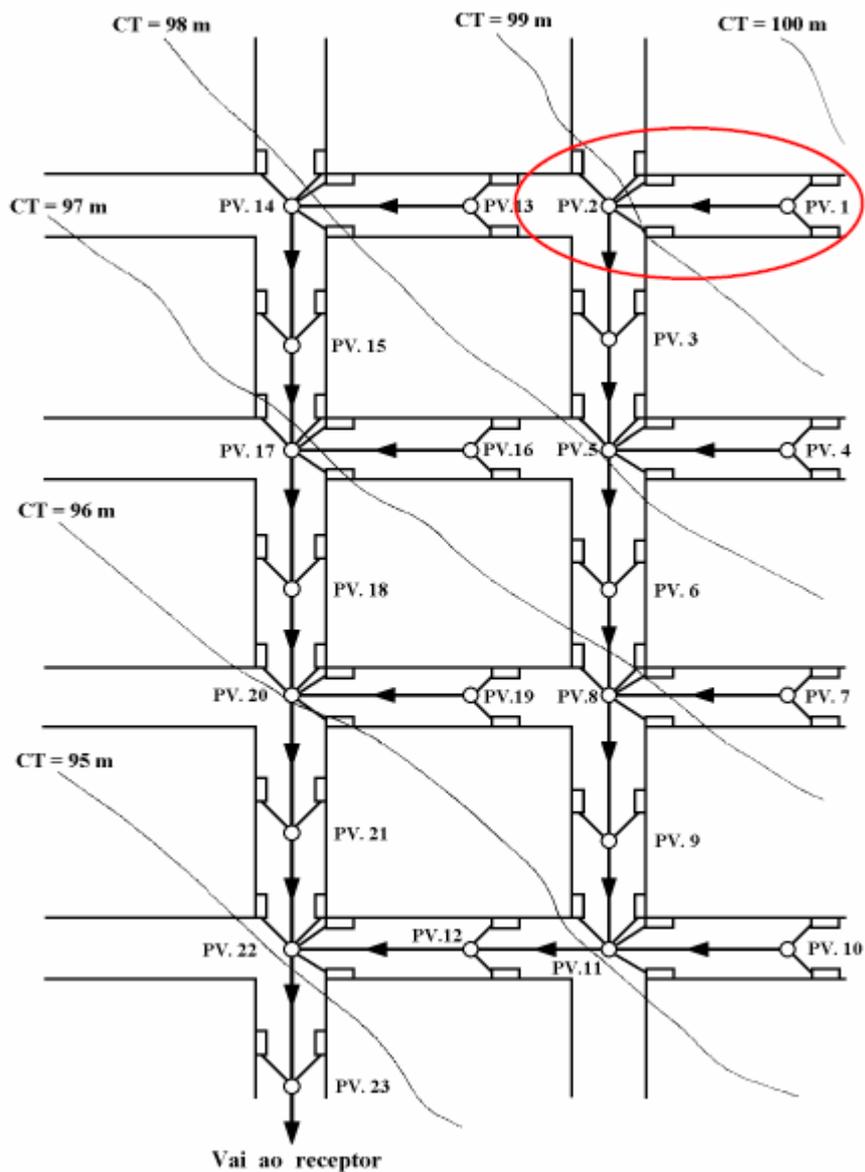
Traçado da Rede Pluvial (FONTE: IPH-UFRGS [5])
